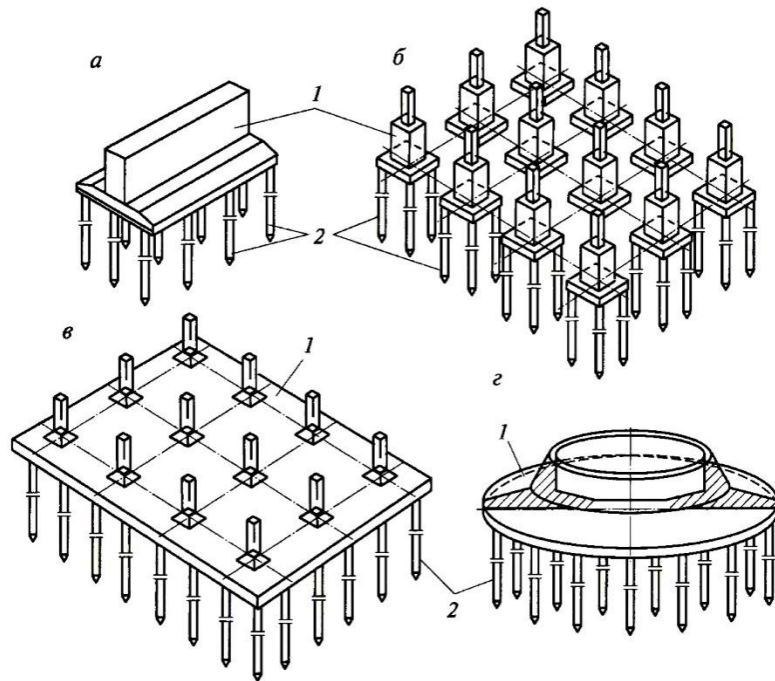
Типи фундаментів глибокого закладення (пальових) для промислового та цивільного будівництва:
